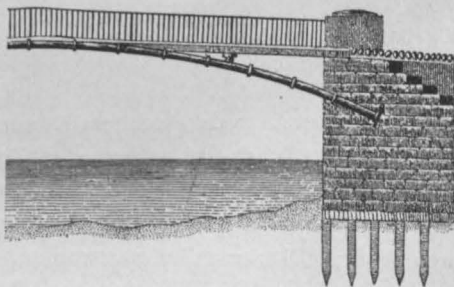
Ansicht einer kleineren Bogenbrücke (nach REICHENBACH). 1811.
